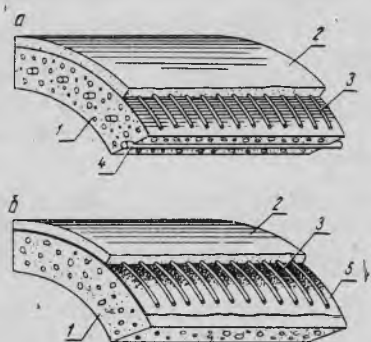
Конструкции железобетонных предварительно напряженных напорных трубопроводов:
